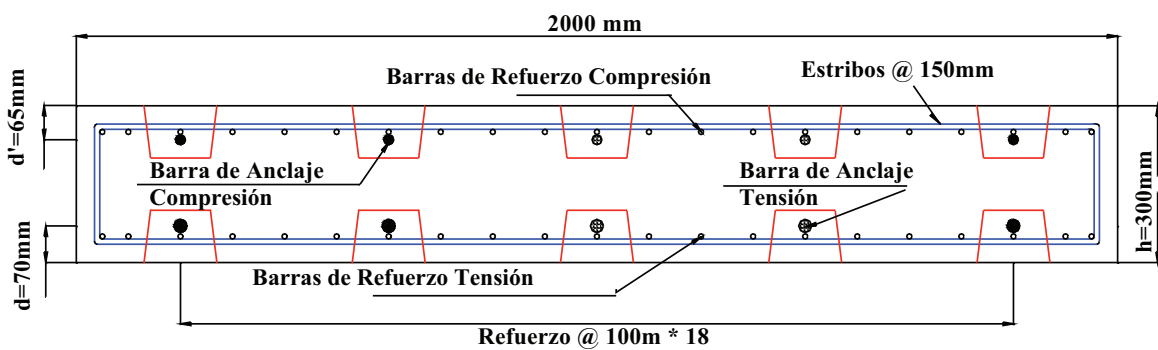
Vigas Pre-fabricada tipo: Sección Transversal.
